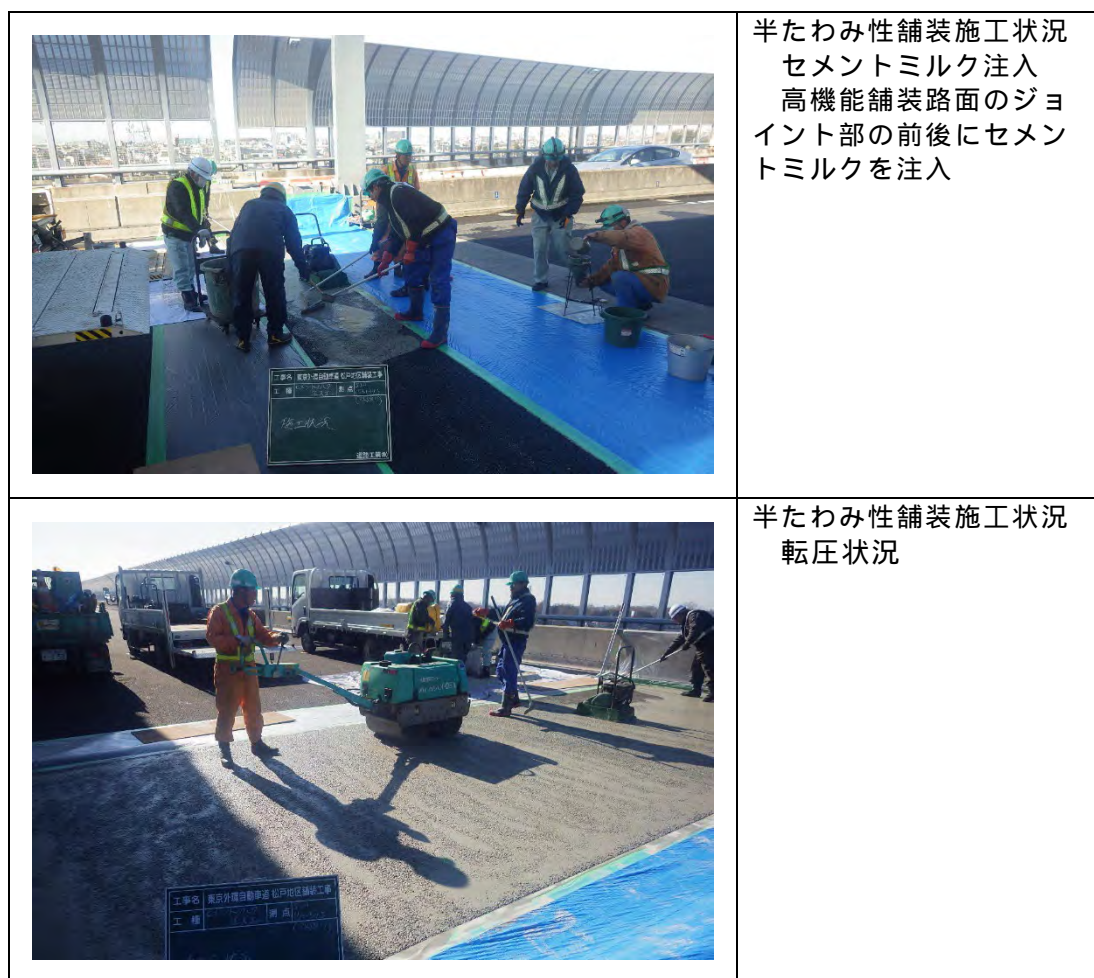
ジョイント部の段差発生を抑制する半たわみ性舗装の施工状況
